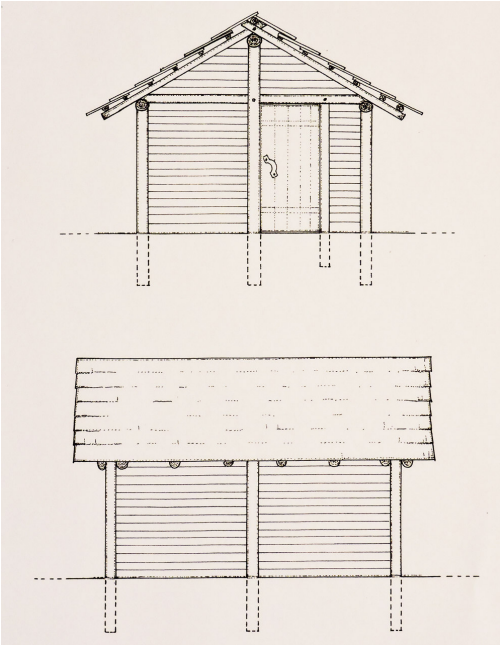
Bauskizze zum neuen Schmiedemodell in Asparn. Ein Pfostenbau mit Riegelwänden und Lärchenschindeldach nach archäologischen Befunden von Bad Dürrenberg; Dimensionen nach Mšec in Böhmen. – Building plan of the new smithy model in Asparn: A post house with rail walls and a larch shingle roof inspired by archaeological data from Bad Dürrenberg; dimensions from Mšec in Bohemia.
